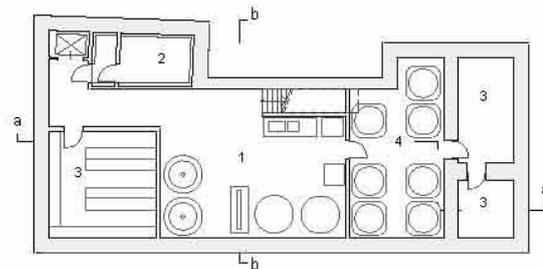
Brauerei Restaurant Kellergeschoss
